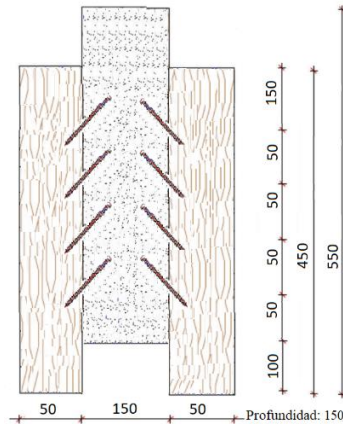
Espécimen de Madera-Hormigón-Madera (MHM).
